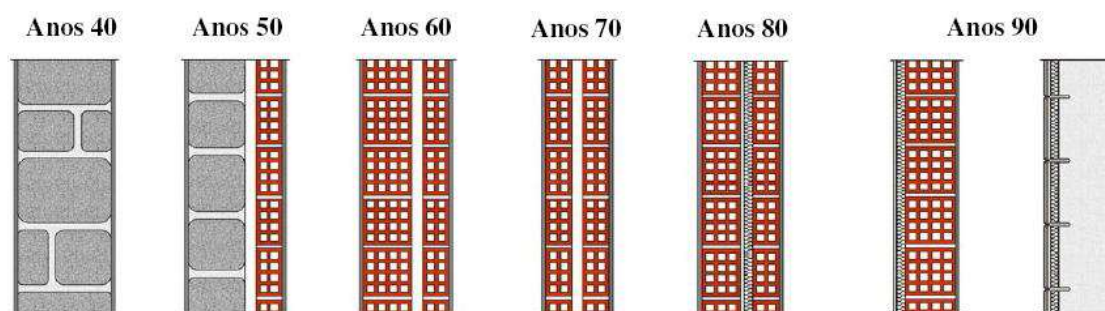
Evolução dos sistemas construtivos de paredes de alvenaria de enchimento de fachada durante o século XX [14].
